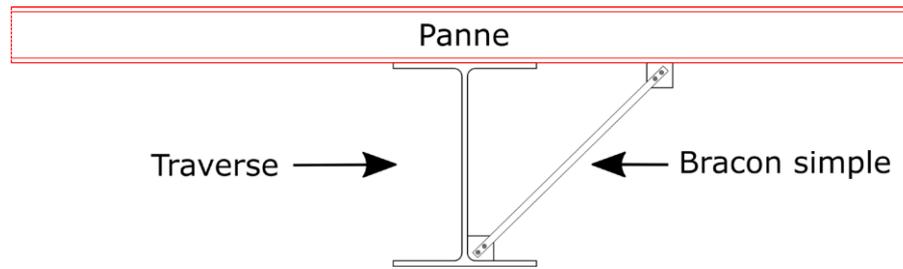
Maintien des semelles de la traverse – Coupe A-A
